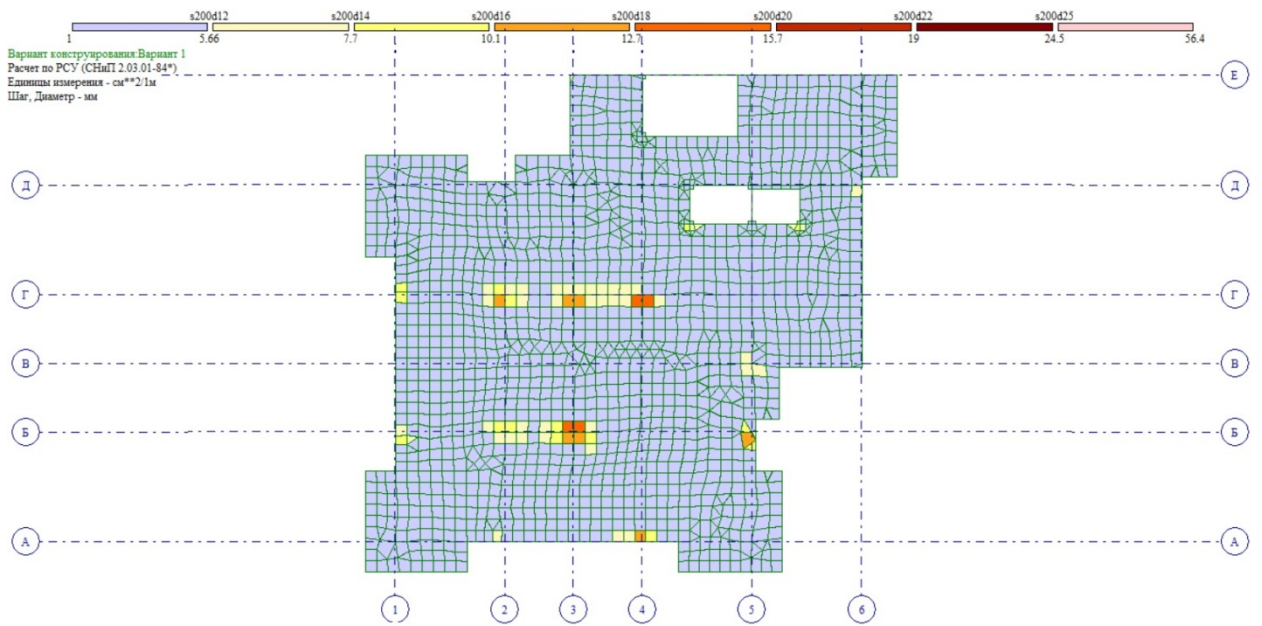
Верхнее армирование плиты вдоль оси Y
